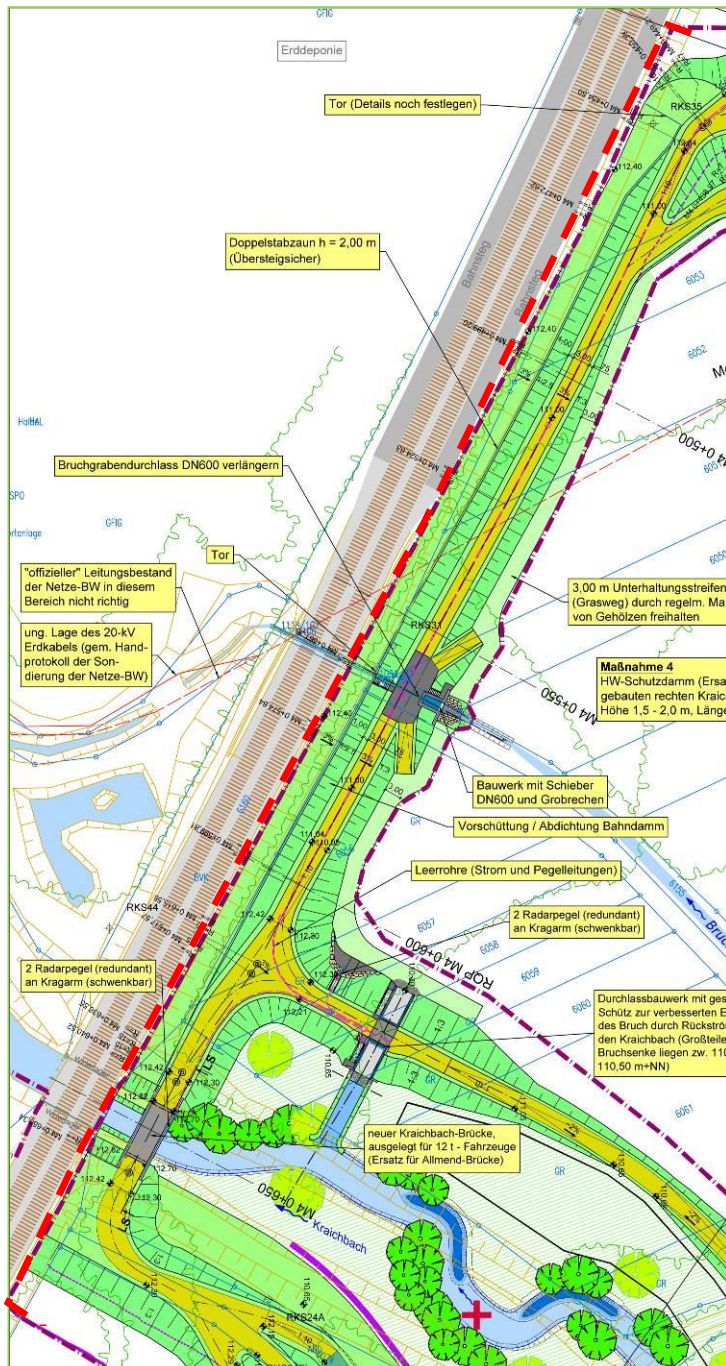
Auszug M4 Lageplan, Teil 1 - Bahndamm Vorschüttung (M 1: 1.500)
